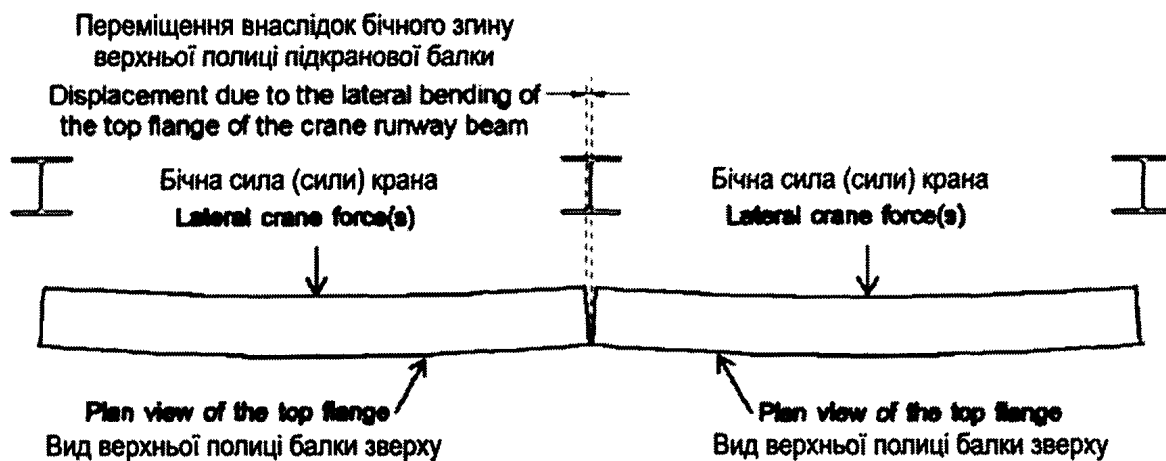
Поворот кінця підкранової балки внаслідок дії бічних сил крана
